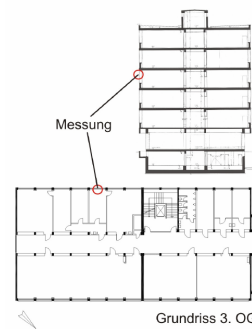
Grundriss und Schnitt mit eingezeichneter Messstation auf 14 m Höhe
